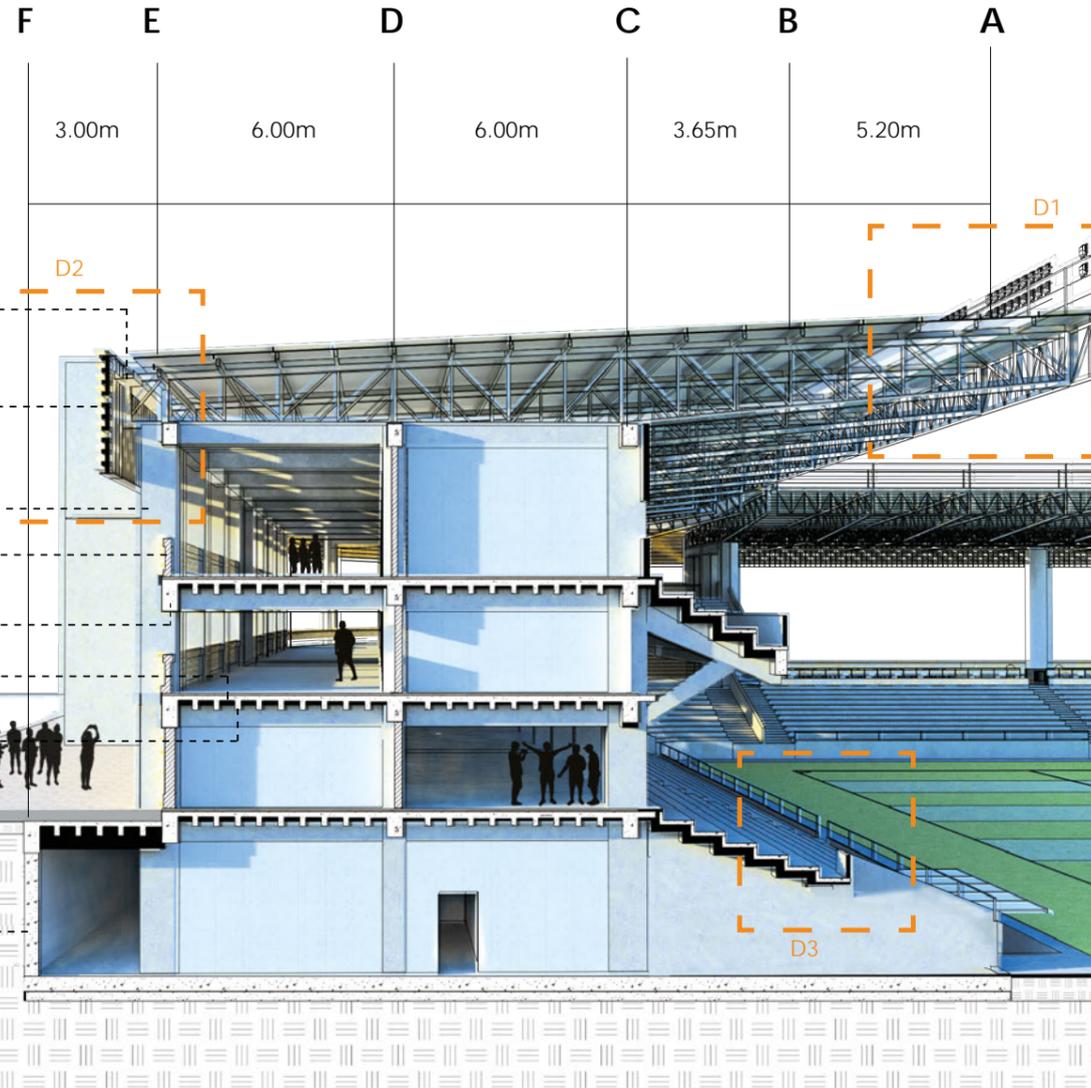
Sección en perspectiva Fuente: Elaboración propia.
